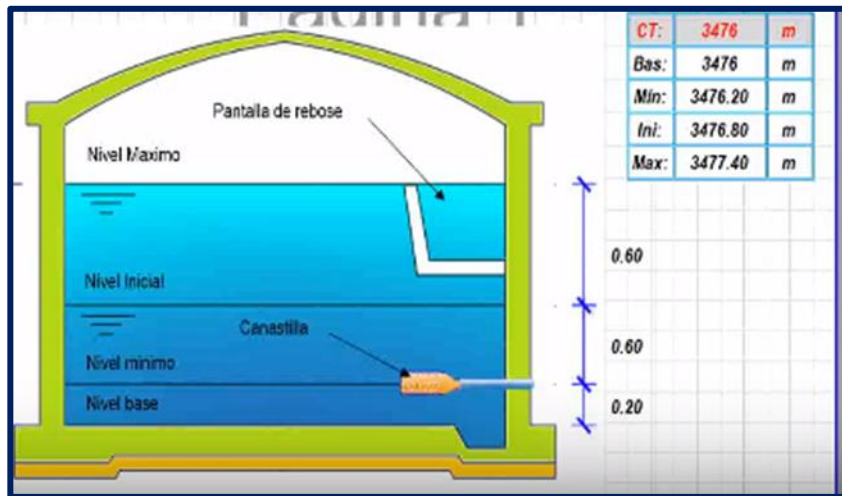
Las parámetros de alturas de un tanque apoyado.
